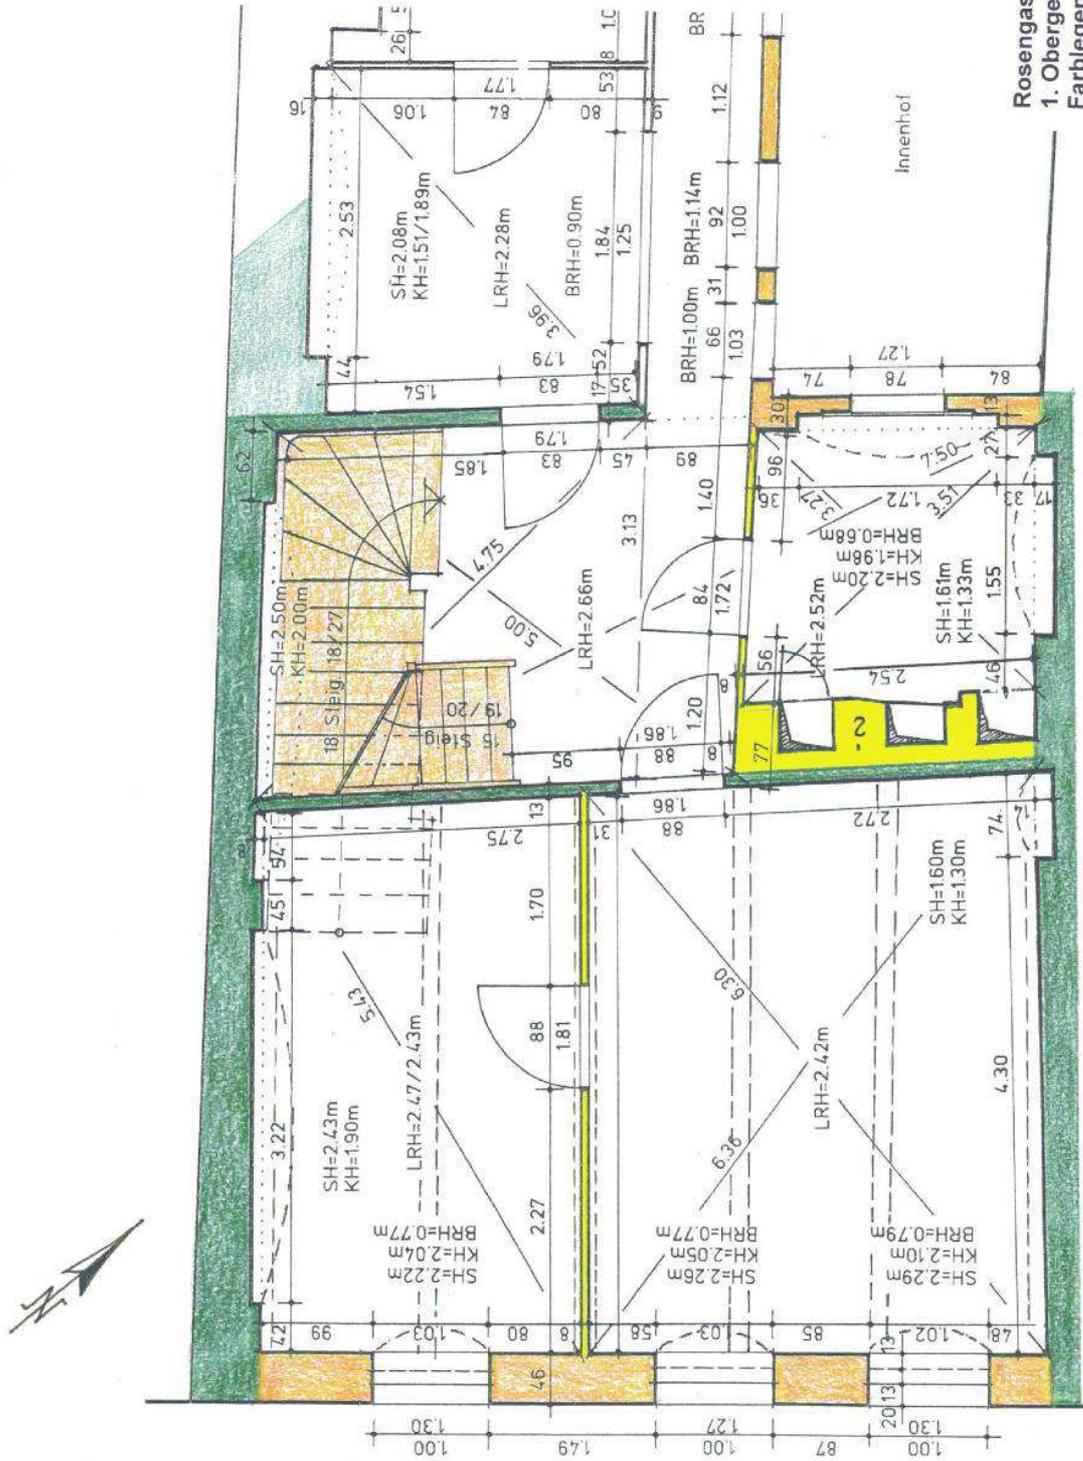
Rosengasse 9, Grundriss Vermessung Obergeschoss
